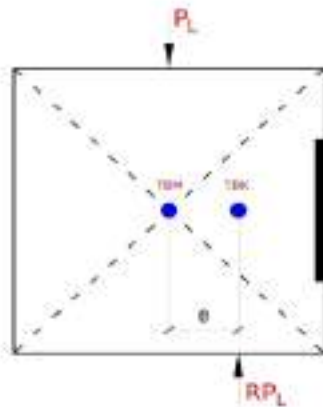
Perencanaan inti bangunan (core) memperhatikan konfigurasi bangunan, kaidah-kaidah perencanaan bangunan tinggi, dan ditempatkan menerus secara vertikal sampai pondasi.
